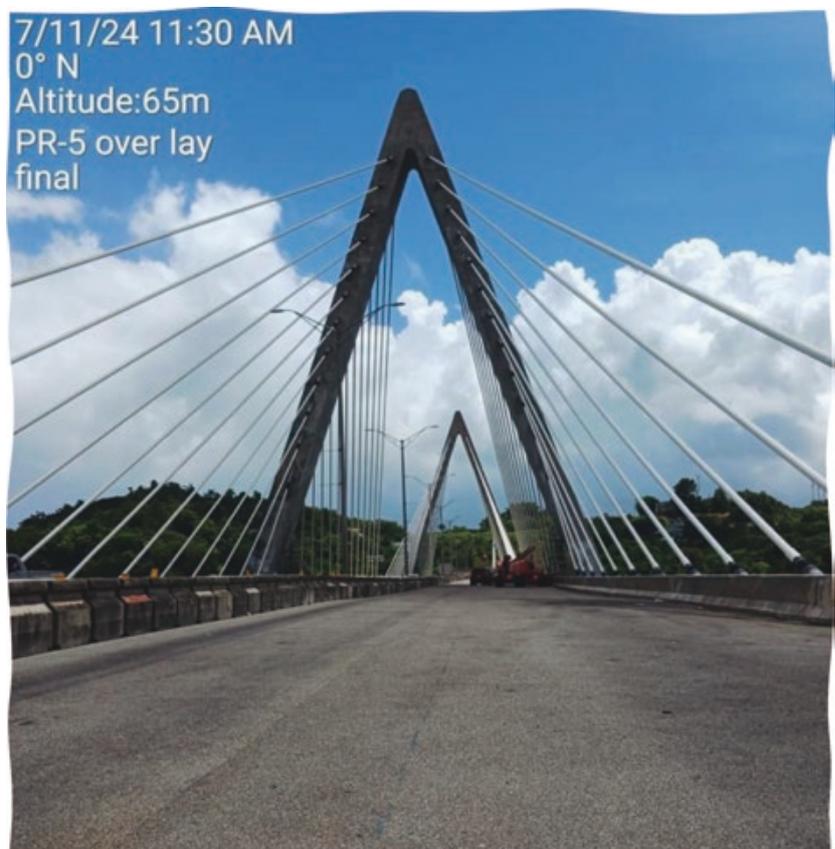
Puente Atirantado de Naranjito. Fuente: ACT.
